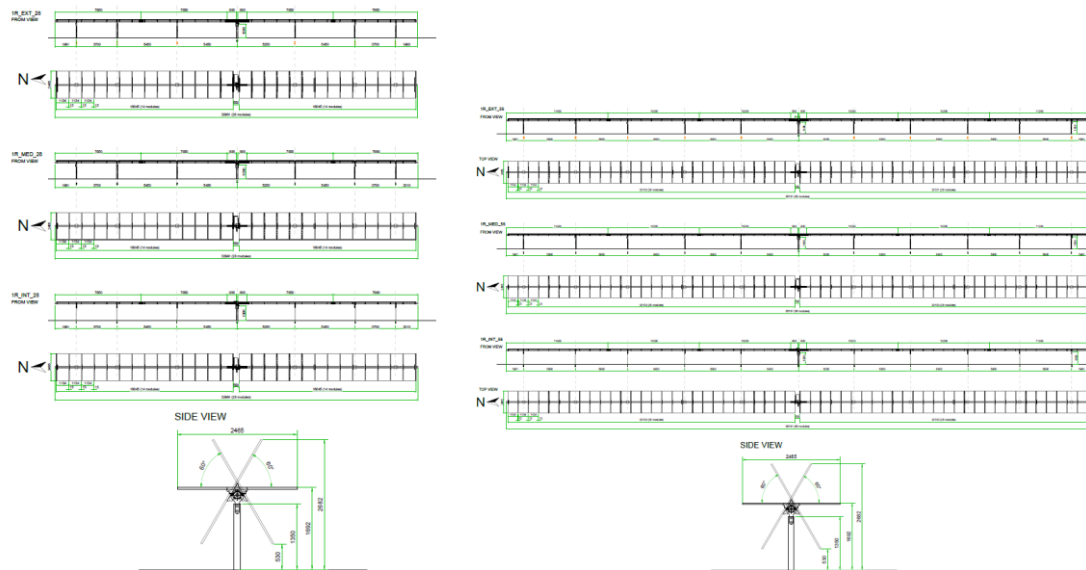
Planos de la estructura 1V. Fuente: PVH.
